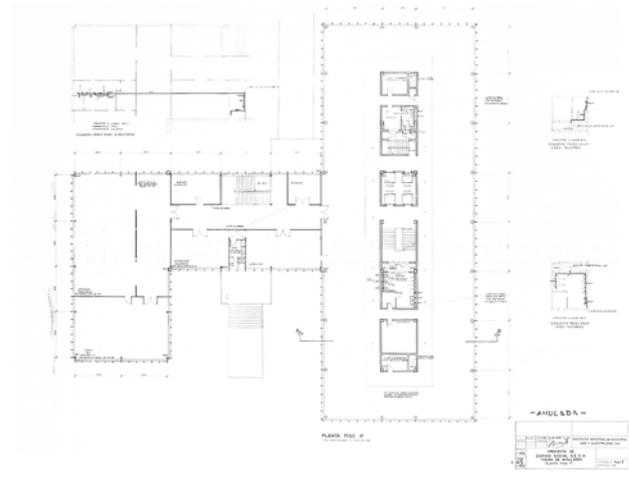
José Ferragut Pou. Planta primera del Edificio GESA, Palma, 1963-1975. Archivo José Ferragut Pou.
